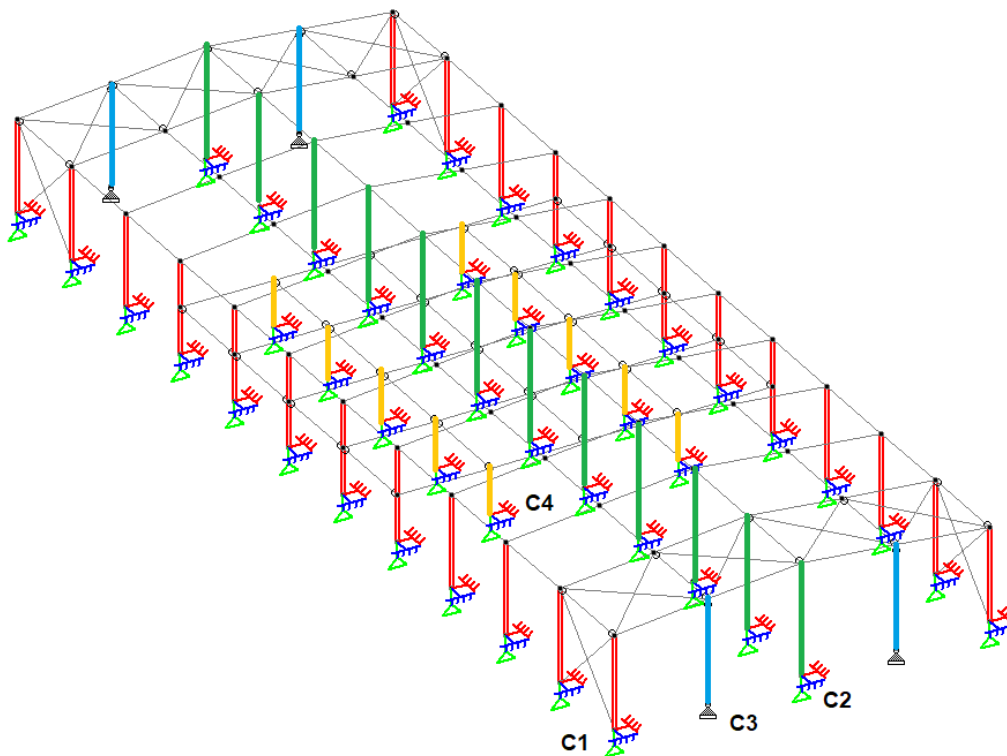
Modelo 3D de estructura resistente - Columnas. Fuente: Elaboración propia.
